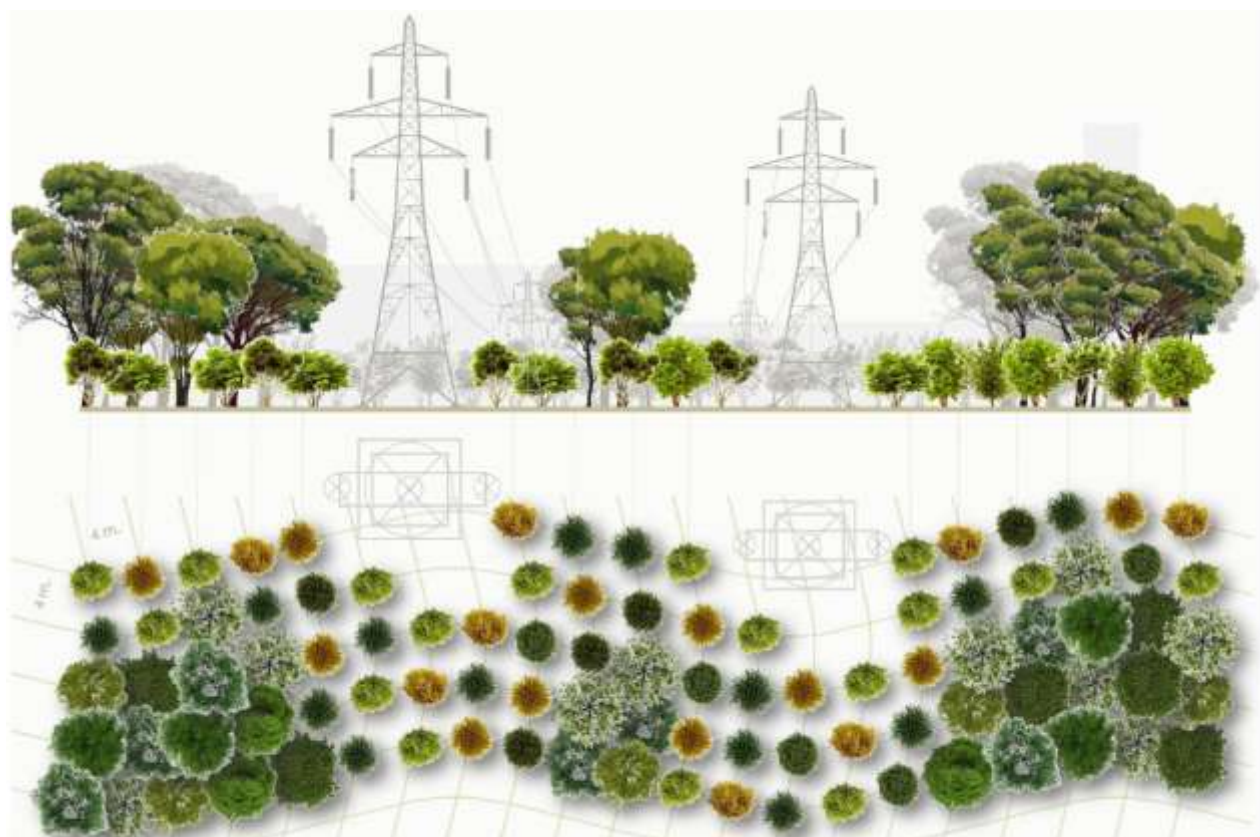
SCHEMA CARATTERISTICO (PIANTA E SEZIONE) IN AREA A FORTE ANTROPIZZAZIONE.
